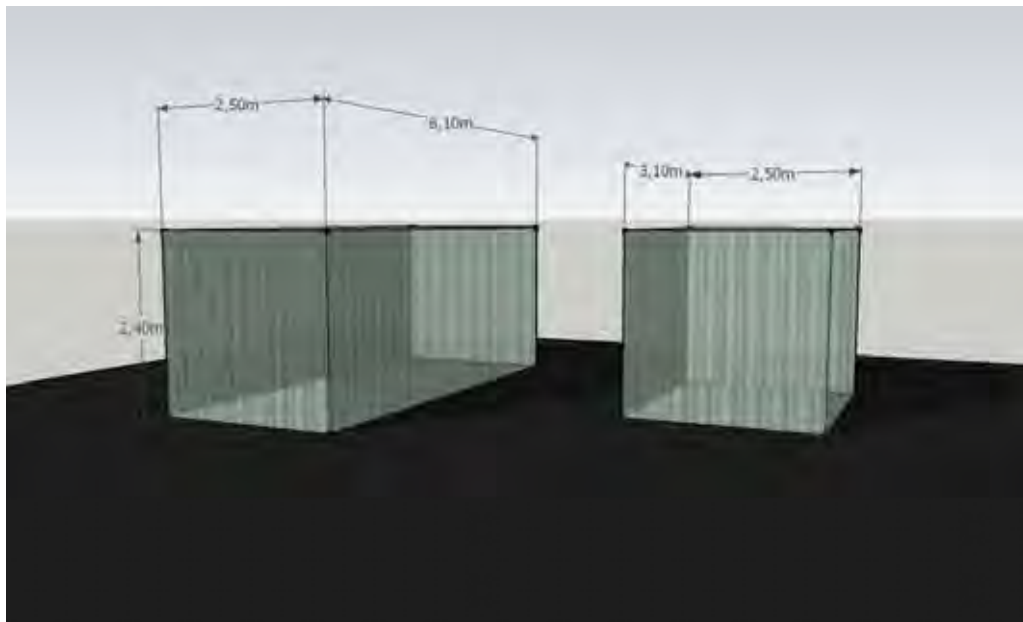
Módulos A y B. Fuente: Elaboración propia 2007
